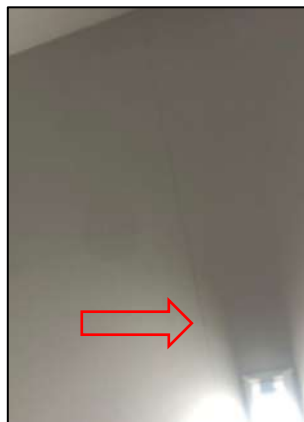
Fissura no forro de gesso. Fonte: (Autoria própria, 2020)
